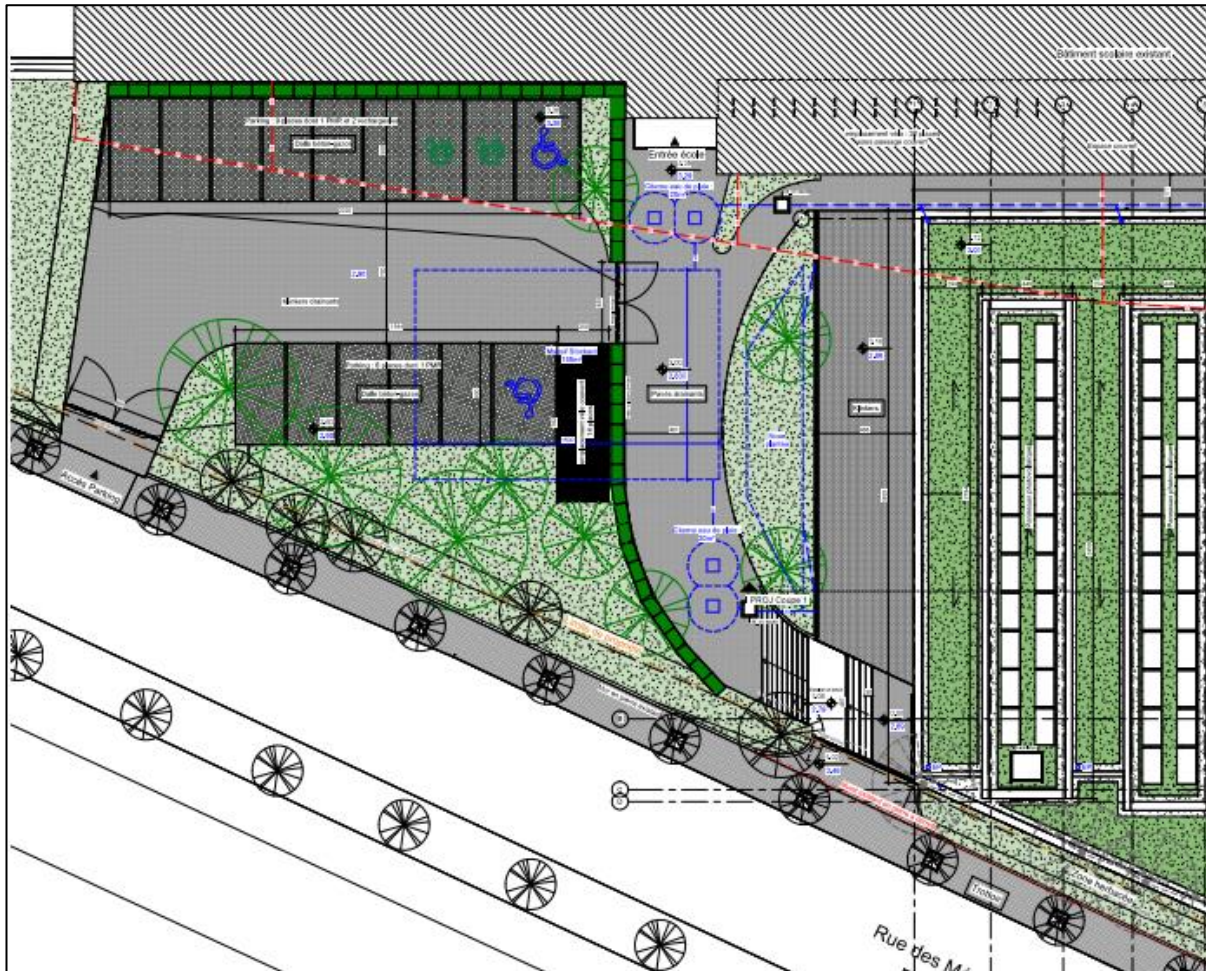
Vue en plan de l'organisation projetée du parking paysager et de son accès (Source :
